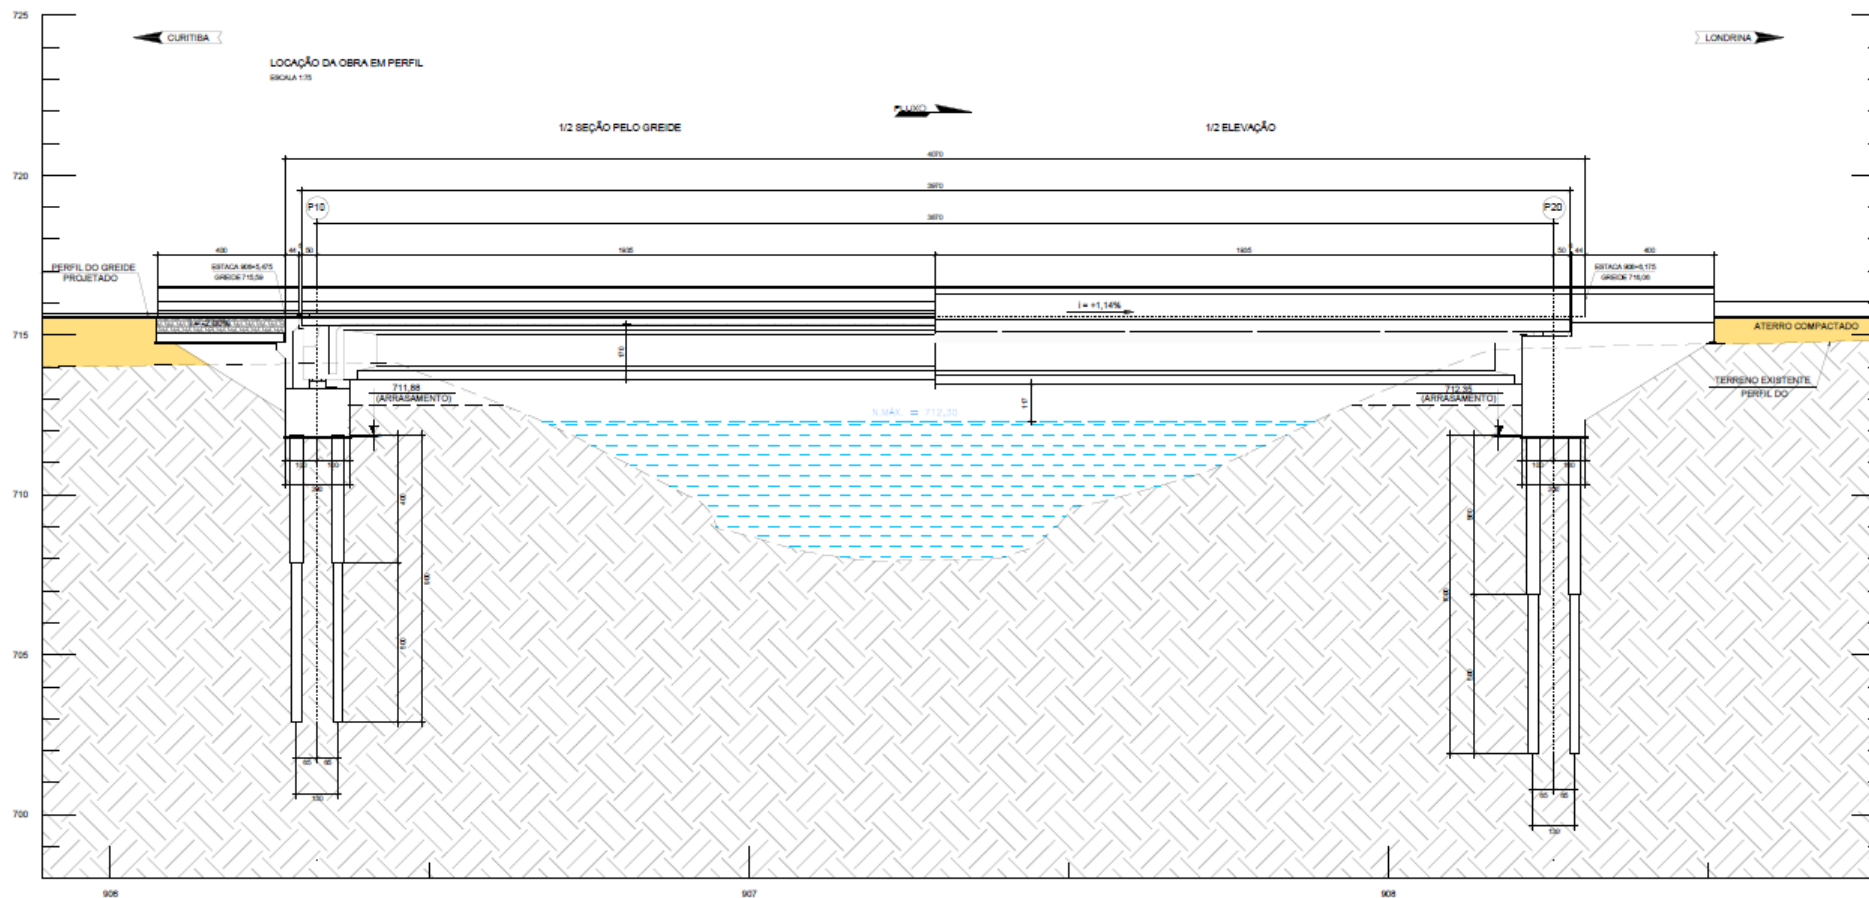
Perfil Longitudinal da Ponte do Rio Santa Cruz
